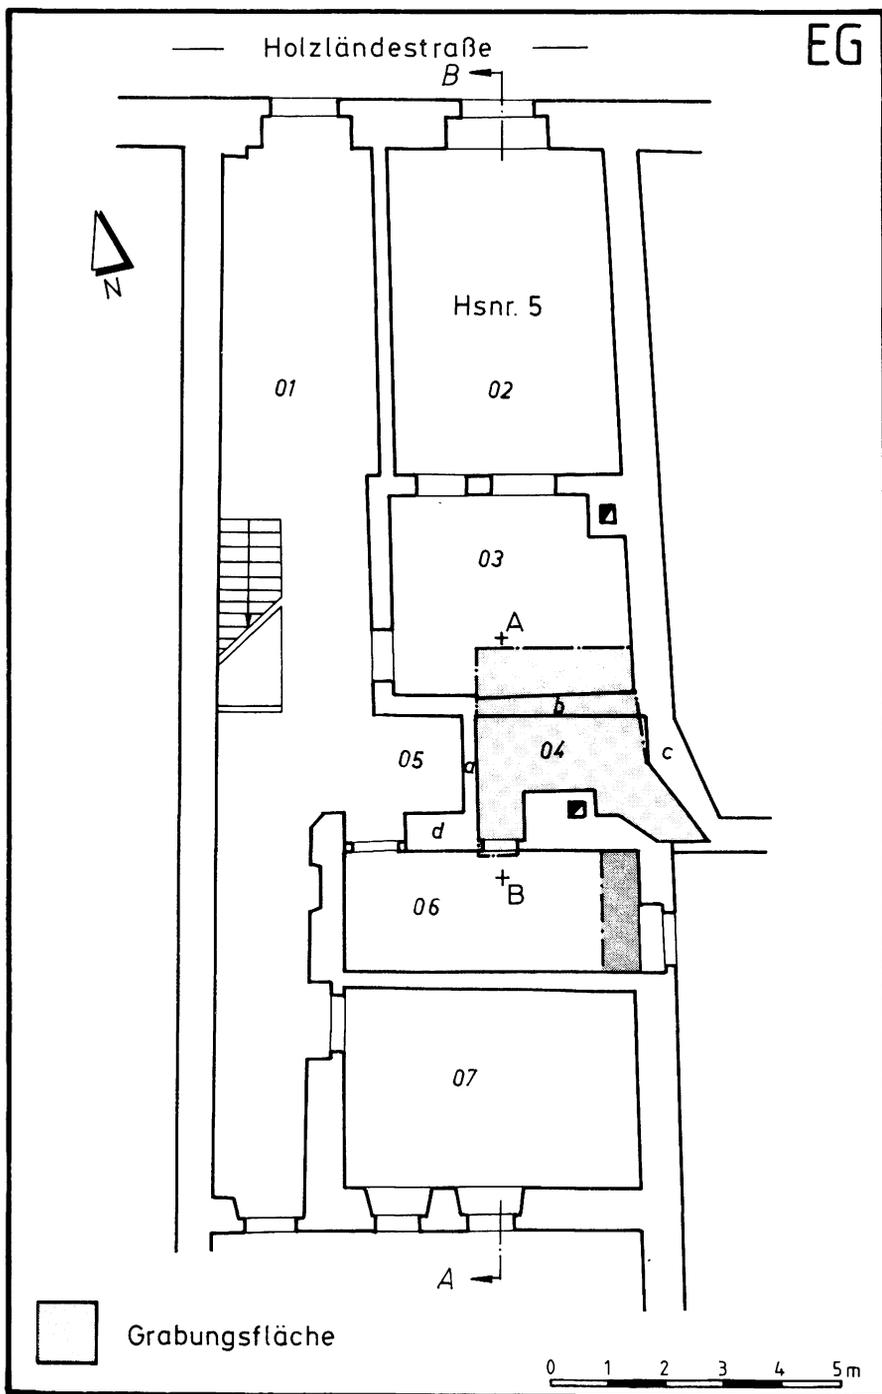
Grundriß Erdgeschoß (schematisiert) mit Grabungsfläche (= Mikweh) und Lage des Ziegelbeckens in Raum 06
